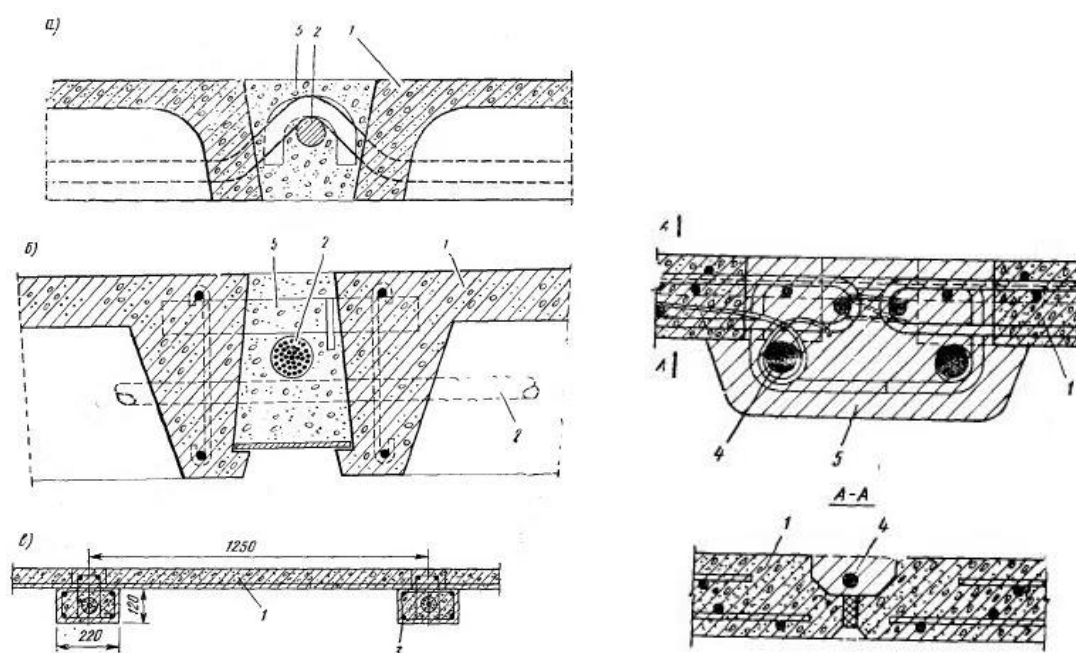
Узлы вантовых покрытий с заполнением из сборных железобетонных плит
